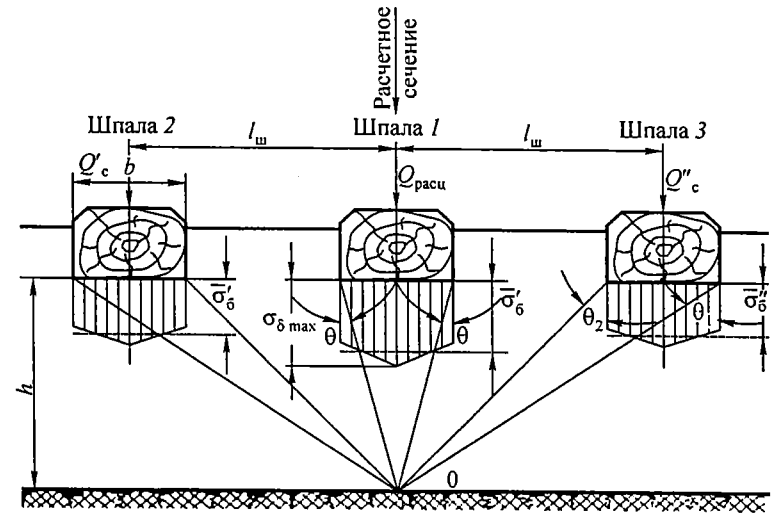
Расчетная схема определения напряжений на основной площадке земляного полотна:
